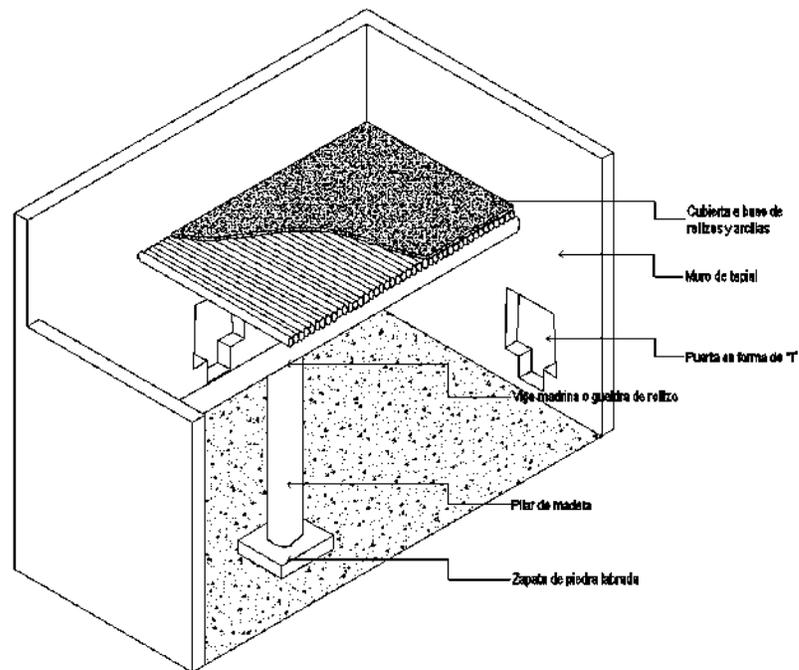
Imagen del sistema constructivo Pre-Jesuitico en donde se muestran los principales elementos estructurales y constructivos. Elaboró: Ramón Holguín.
